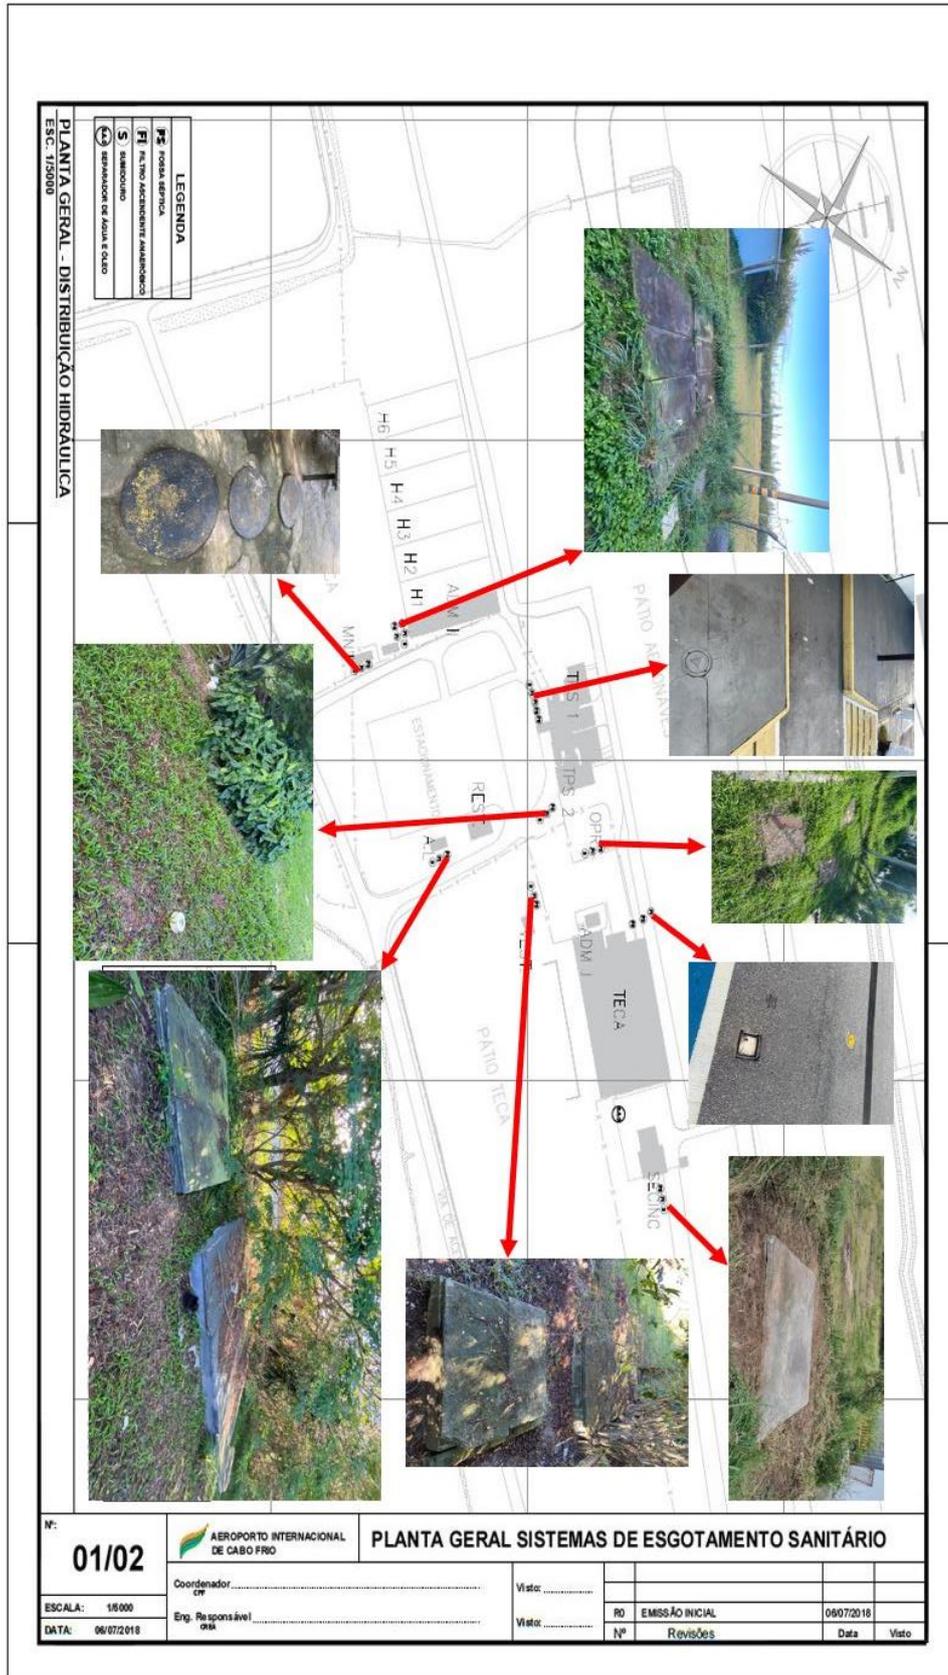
Planta Geral do Sistema de Esgotamento Sanitário em SBCB.
